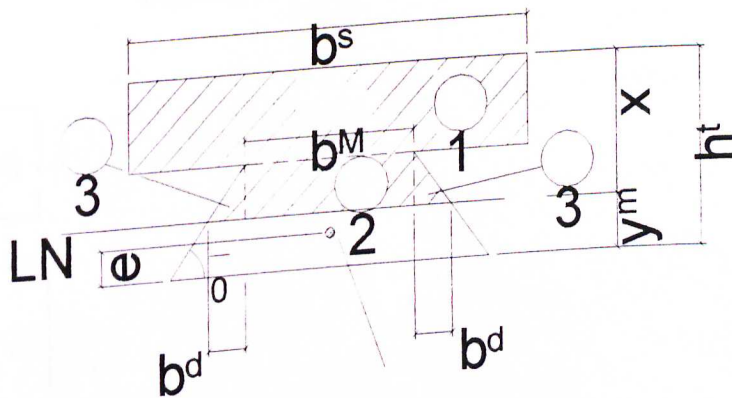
Linha neutra elástica passando pela fôrma de aço. Dimensões utilizadas para o cálculo do momento de inércia da seção fissurada.
